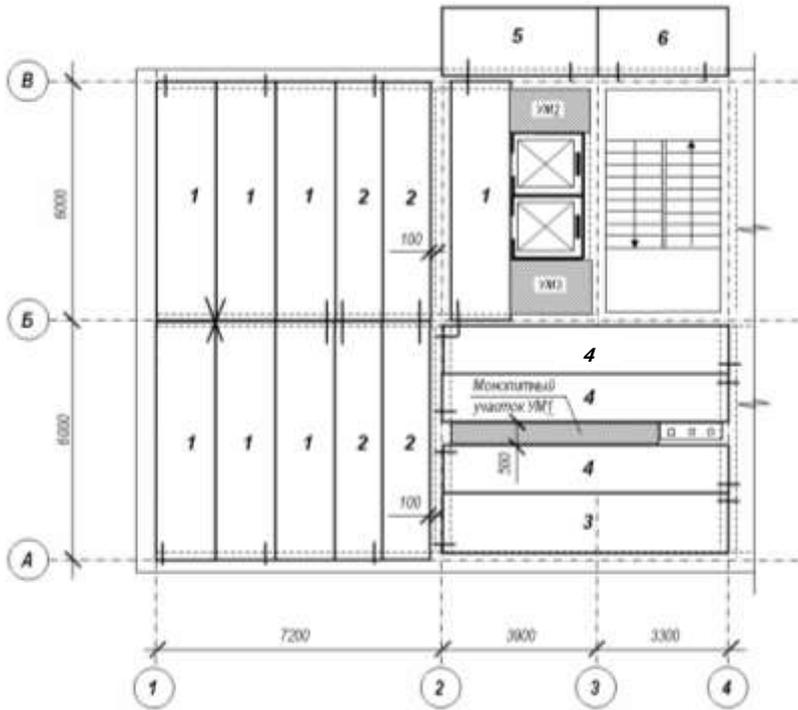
Пример оформления схемы расположения элементов перекрытия (из многупустотных железобетонных плит) жилого дома
